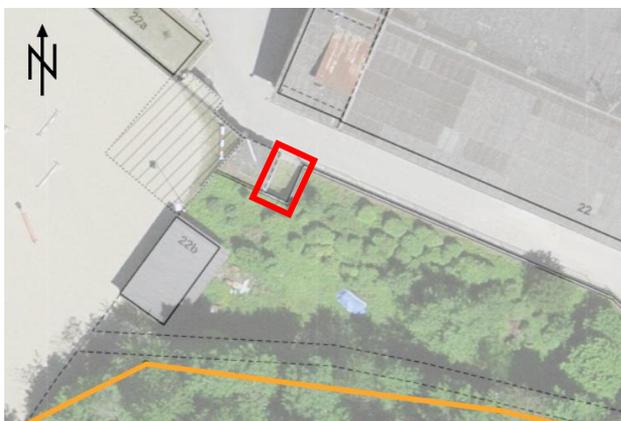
Verortung Neuüberdachung (orange Umrandung = Parzelle Nr. 1476, rote Umrandung = Standort der Neuüberdachung)
